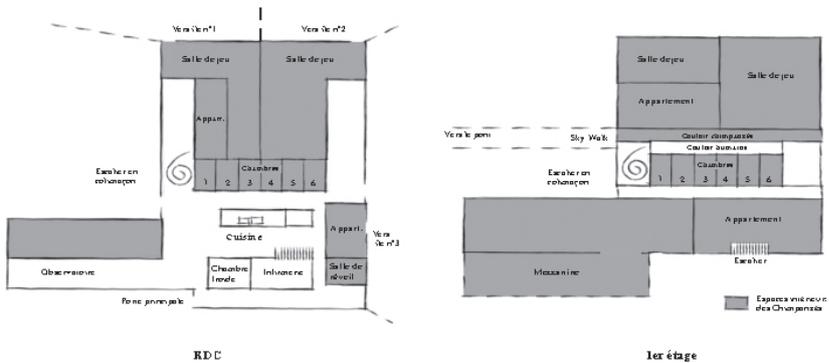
Plan de la *Chimp House* (Fondation Fauna, Québec, Canada).
